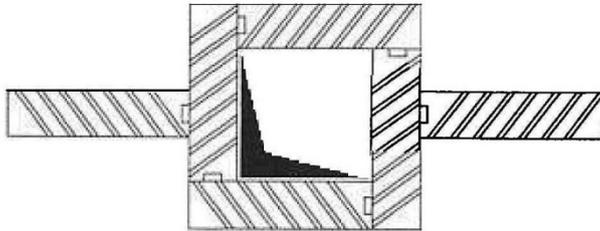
Pilier en blocs de plâtre sur toute la hauteur de la paroi
